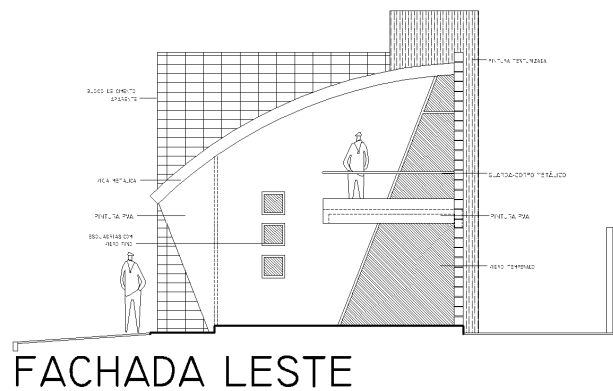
Projeto 2 – Fachadas e Perspectiva
